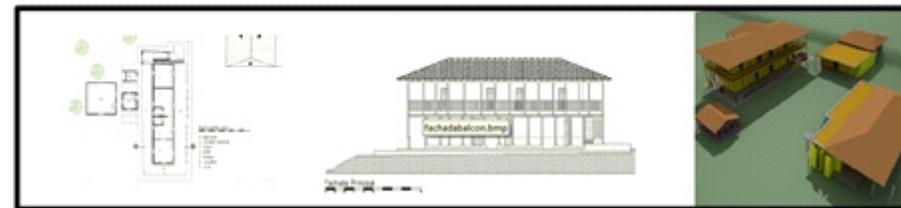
Viviendas de dos pisos con teja de barro o en techo elba o mixto
